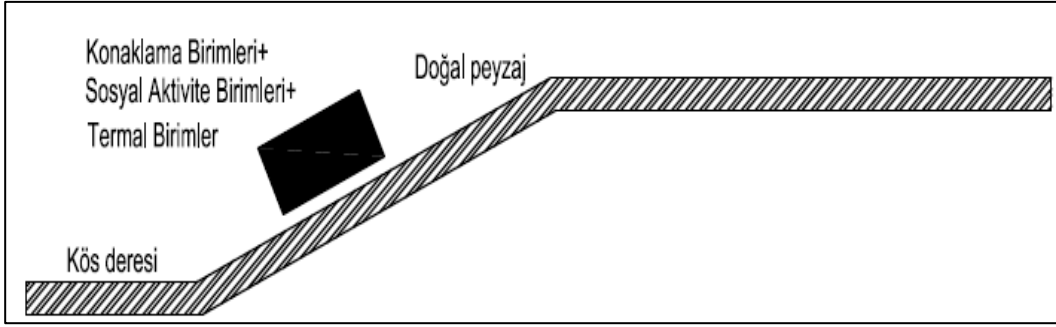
Bağın termal tesisleri yerleşim planı
